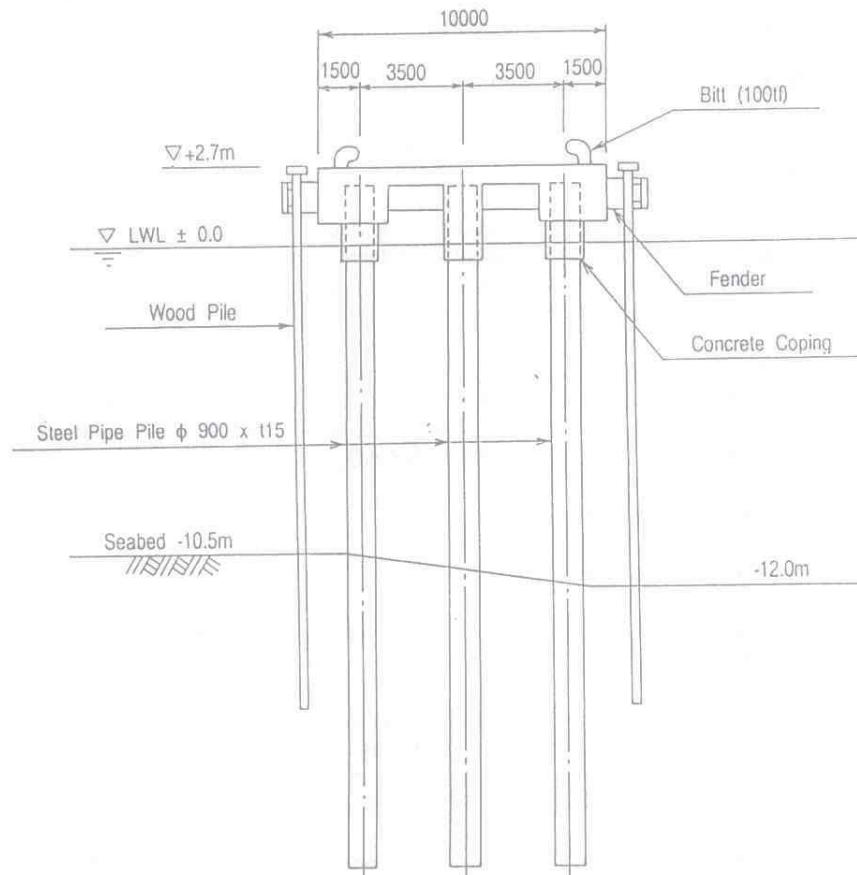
Sección Típica Atracadero Contenedores -12 m
